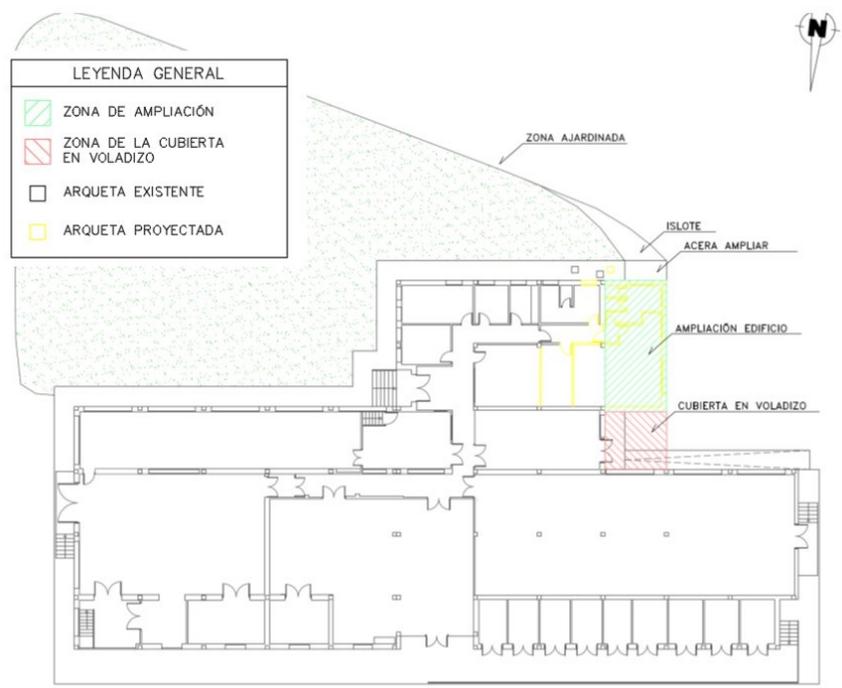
Nueva configuración de los viales en la zona norte
